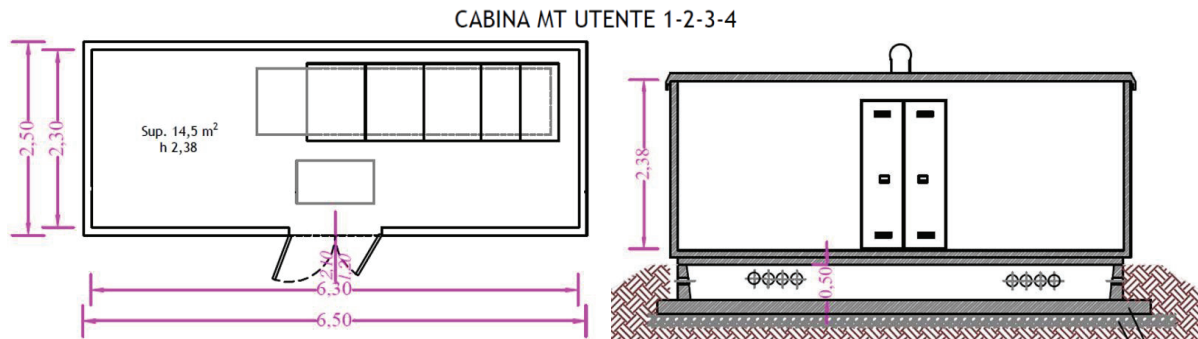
Pianta e profilo delle cabine MT utente 1-2-3-4
